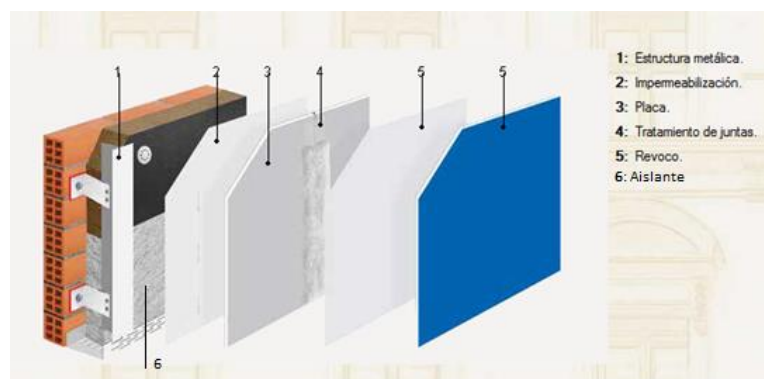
Fachada Ventilada PLACOTHERM. Fuente: Arquimedes
